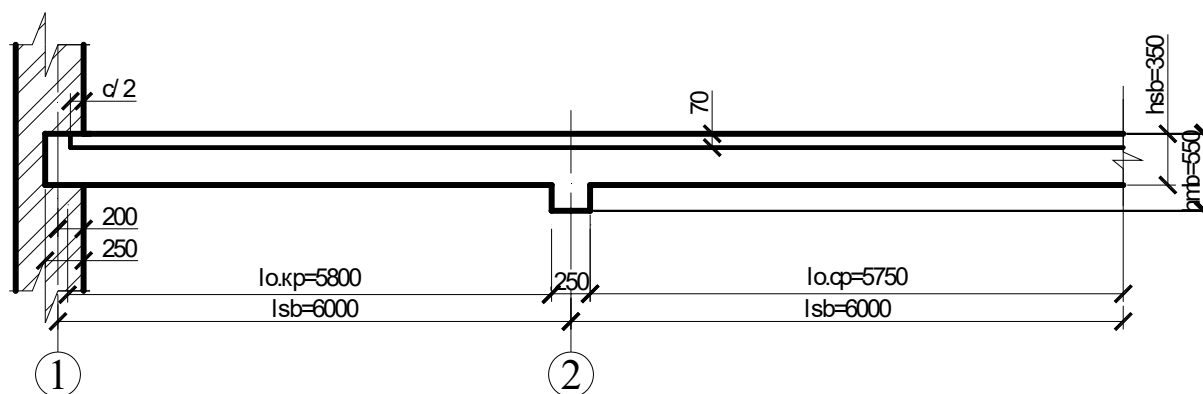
К определению расчетных пролетов второстепенной балки
